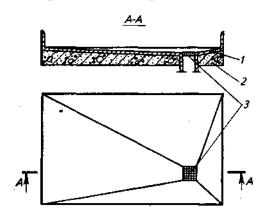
Схема «конвертовки» и герметизации полов: 1 — гидроизоляция; 2 — железобетонное перекрытие; 3 — трап
